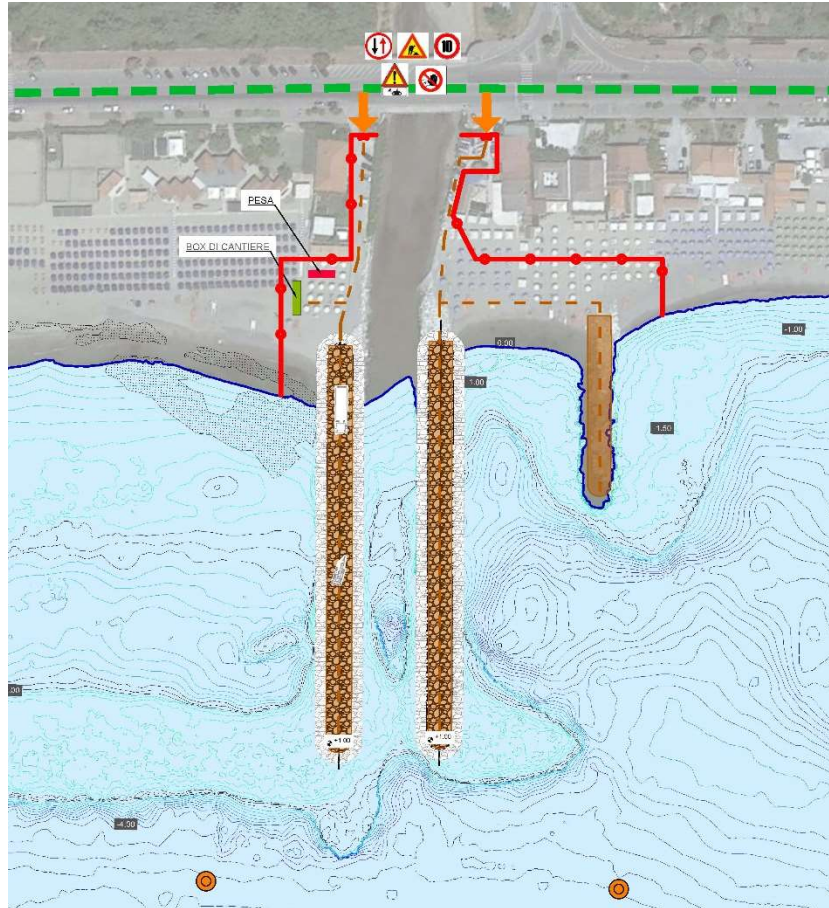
Planimetria cantierizzazione AREA A Fosso Magliano
